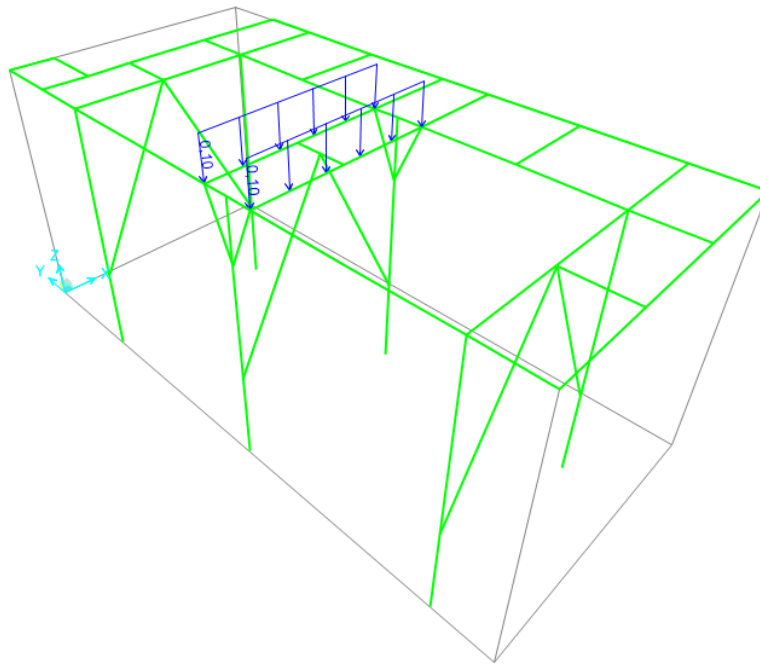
Aplicación de cargas peso de plancha zona 2
